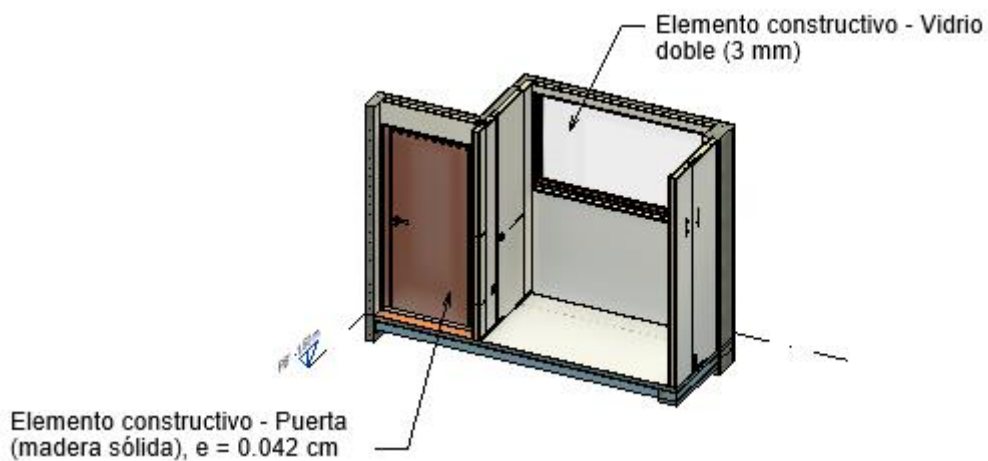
Elementos constructivos: vidrio doble y puerta de madera sólida
